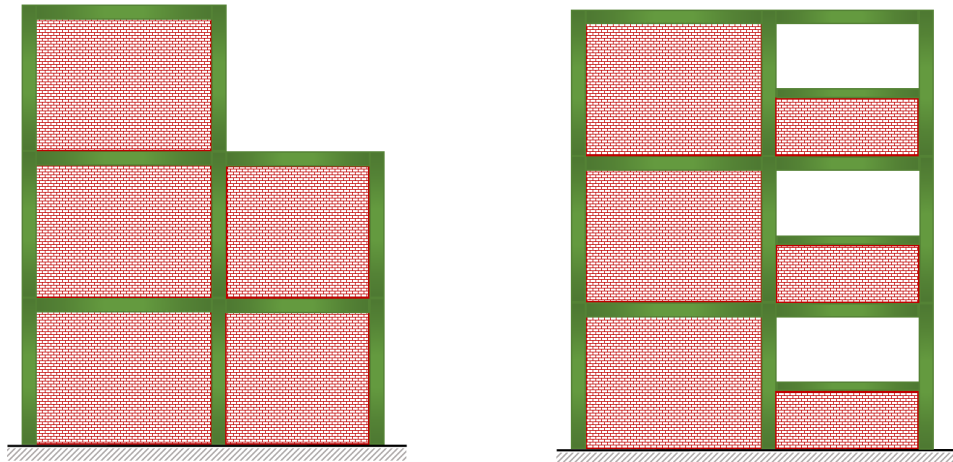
Muros de mampostería encadenada sin y con aberturas.
